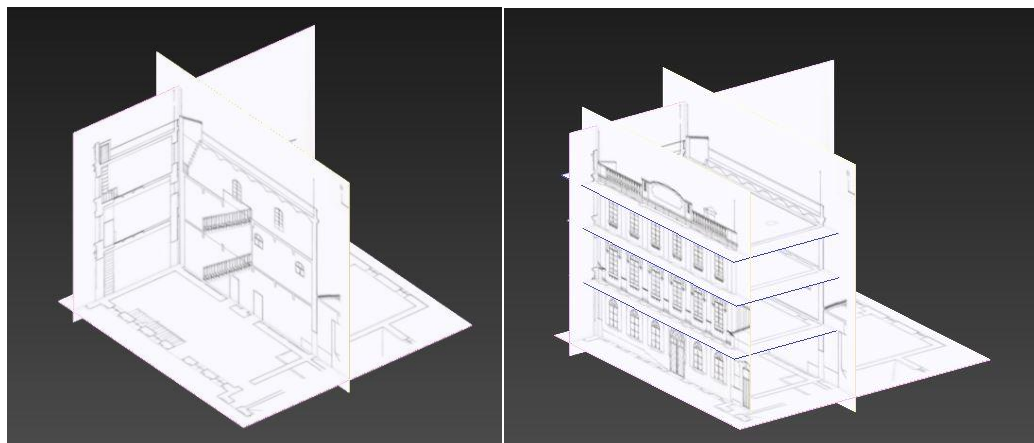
Disposición de los planos una vez texturizados. Vistas alzado interior, planta de la planta baja y perfil derecho (izq.). Todos los planos texturizados. (dcha.)
